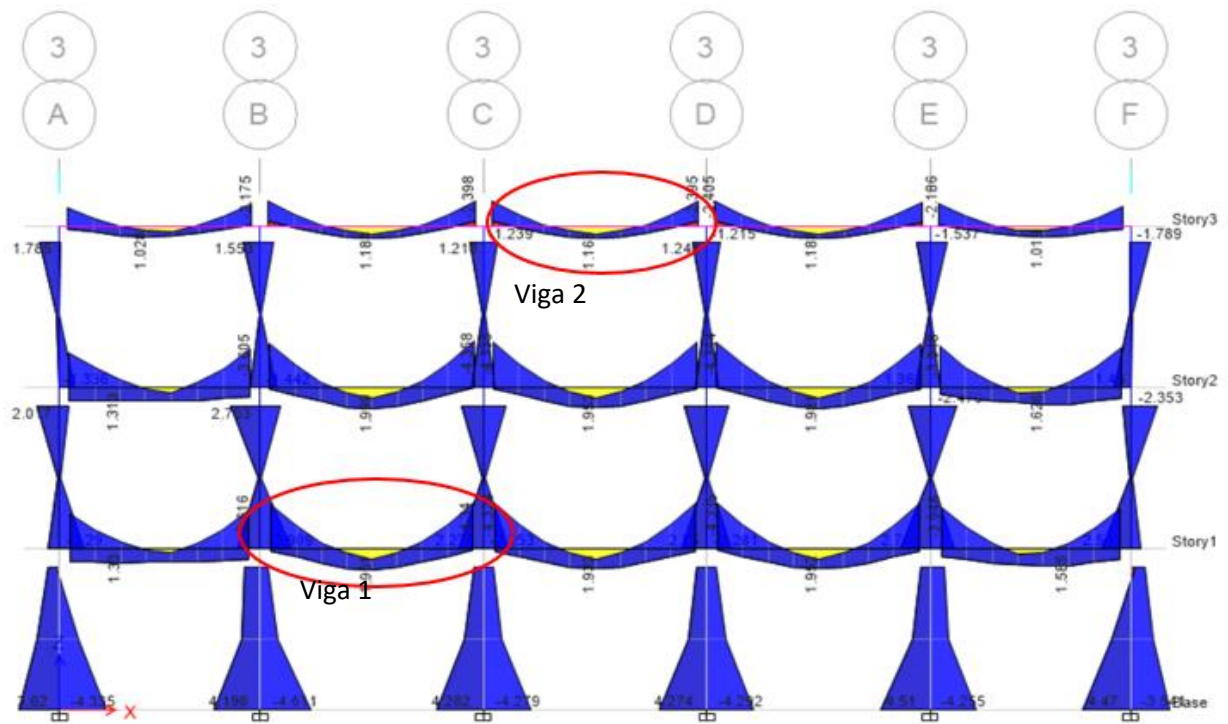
Momento Ultimo en las vigas más desfavorables edificio de 3 pisos
